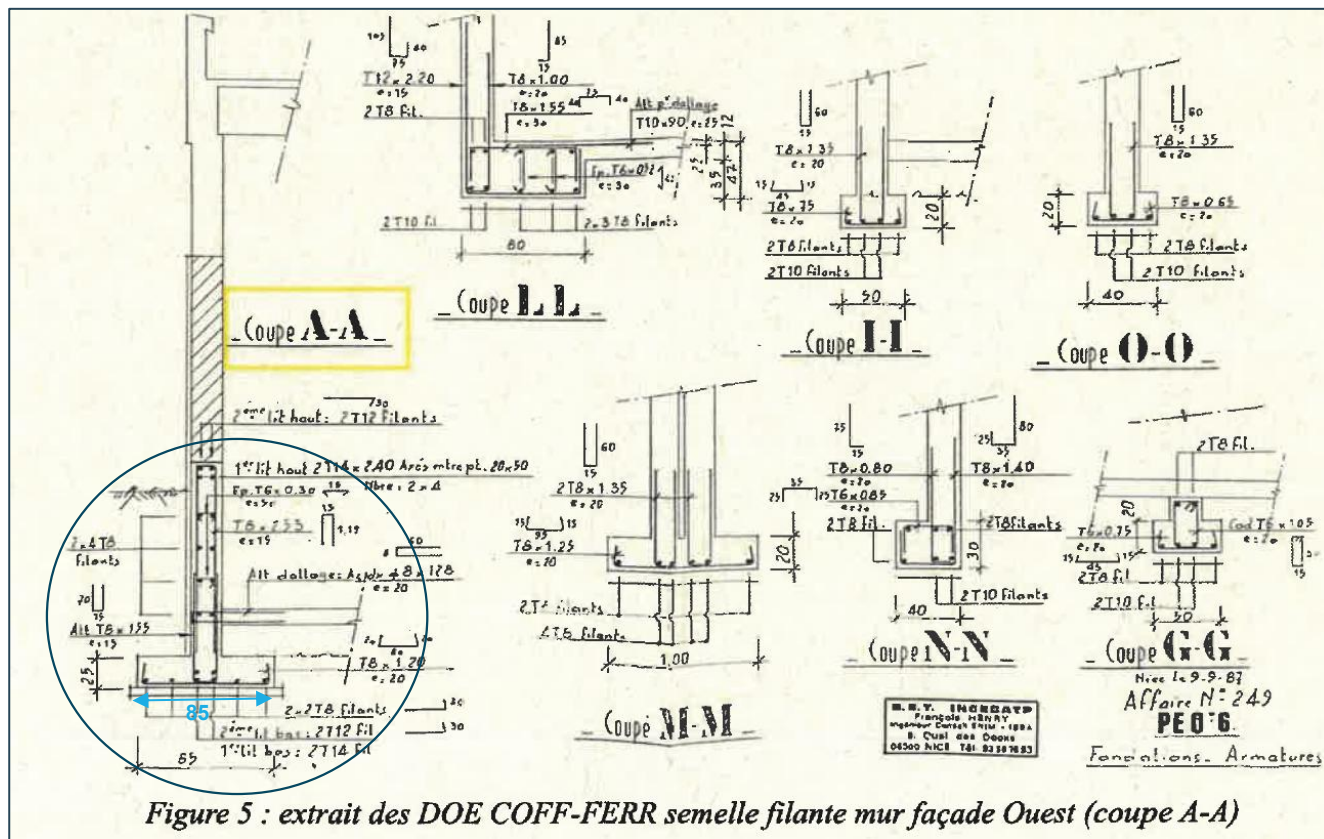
extrait des DOE COFF-FERR semelle filante mur façade Ouest (coupe A-A)
